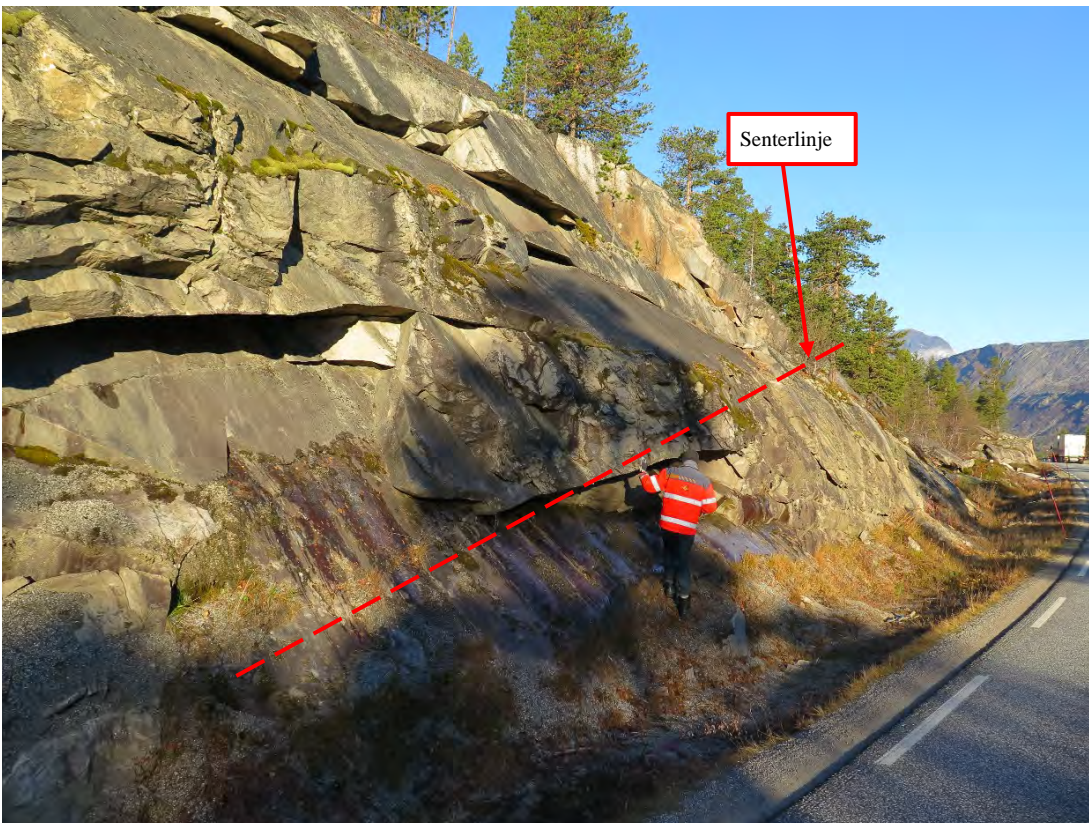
Profil ~7500, planlagt veg kommer gå i skjæring til venstre om eksisterende E6, foto tatt mot nord.
